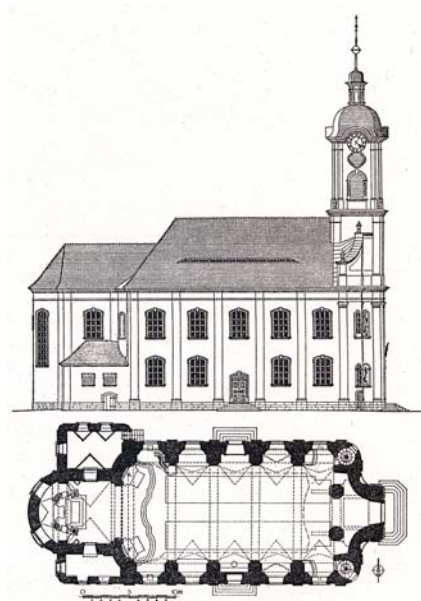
Scheinfeld, Seitenansicht und Grundriss
